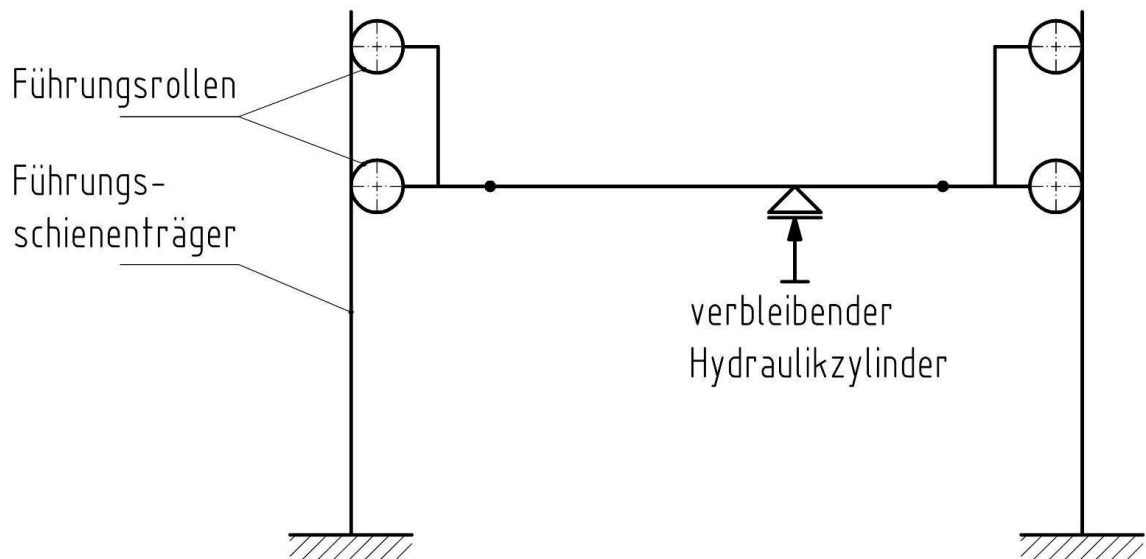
Ansicht Hubteillührung, ein Hydraulikzylinder ausgefallen
